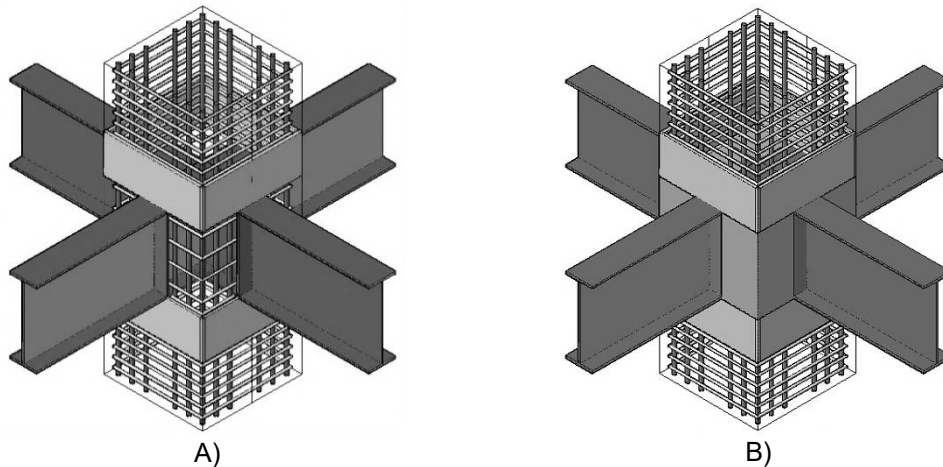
Esquema tridimensional de la conexión A) armado de la conexión B) conexión con concreto en la zona del nodo antes de las placas de banda
